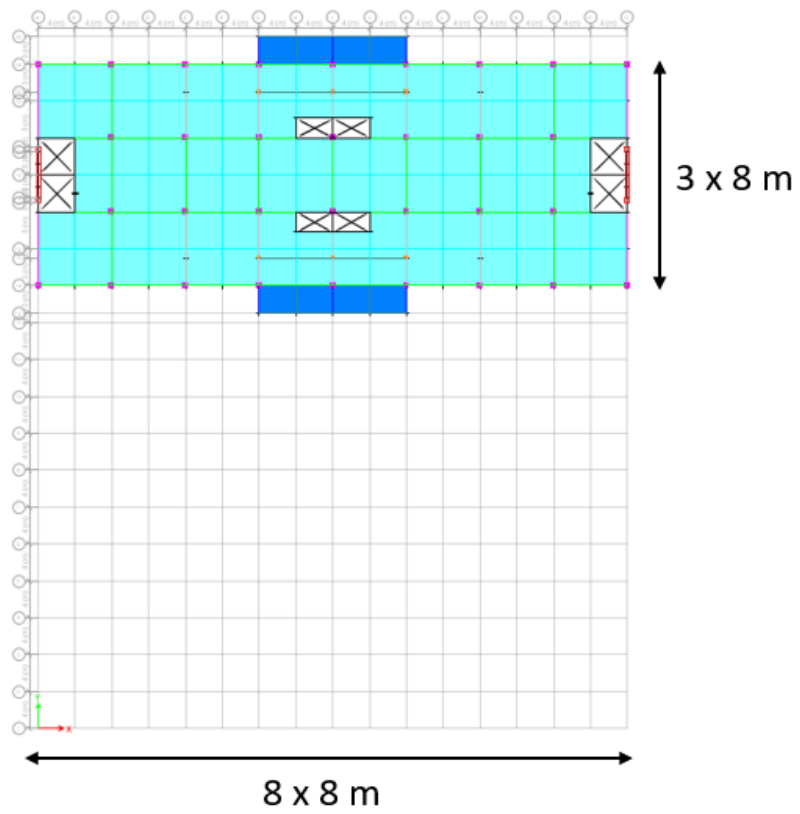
Denah Tipikal Lantai 5 dan 6 Untuk Model 1, 2, 3, dan 4
